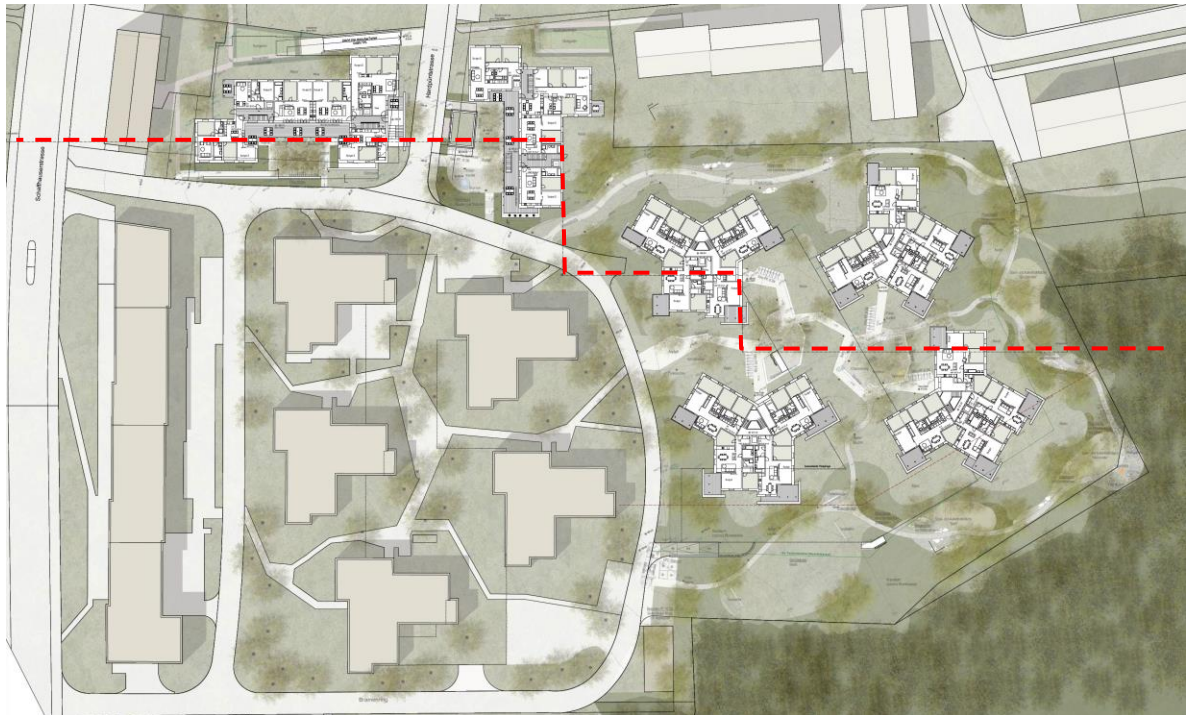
Situationsplan Richtprojekt mit Erdgeschoss
